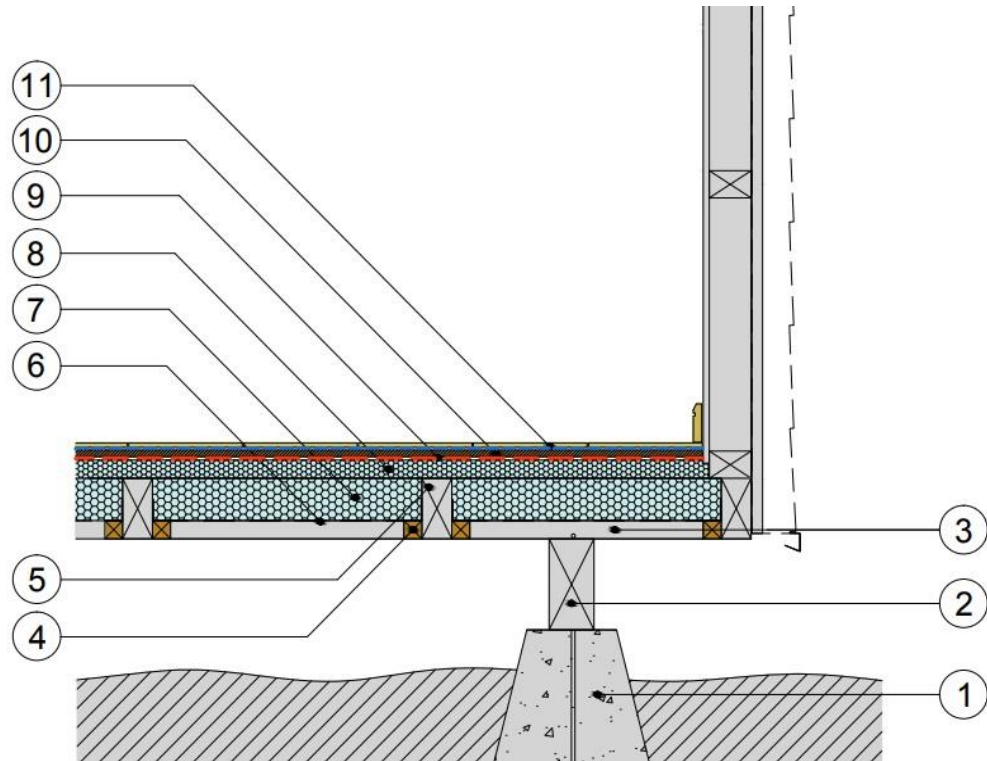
Detalle solución constructiva para piso ventilado PDA Osorno. Fuente [19].
